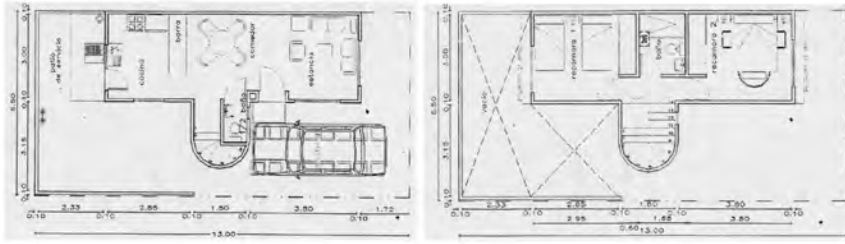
Planta Baja y Alta de Vivienda de Interés Social.
